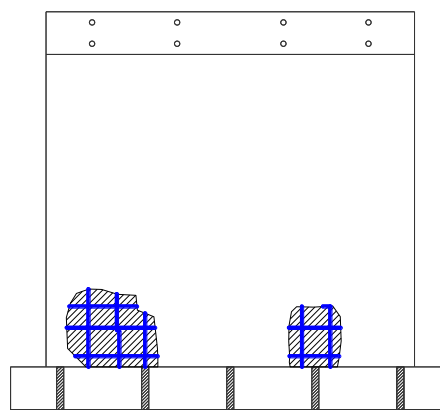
Ningún agrietamiento de muro de albañilería confinada con ladrillos pandereta industrial en la distorsión 1/3000.
